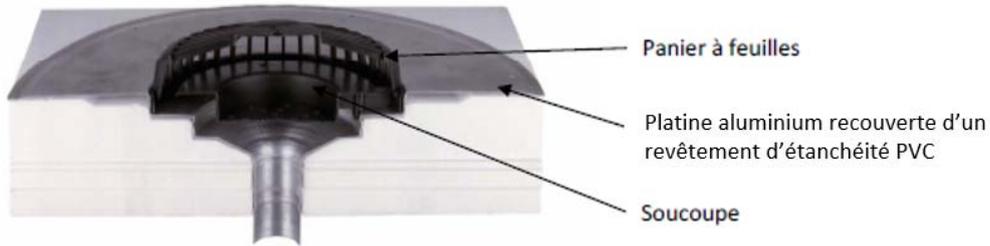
Coupe sur la naissance VACURAIN® associée à un revêtement d'étanchéité PVC
